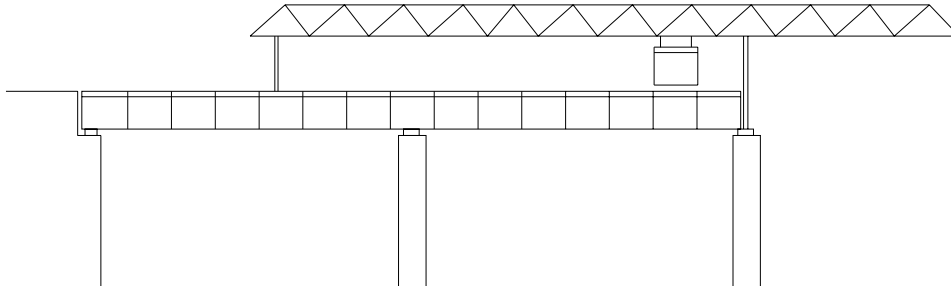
VIGAS PREFABRICADAS DE VANO ENTERO, LANZADAS MEDIANTE GRÚA
